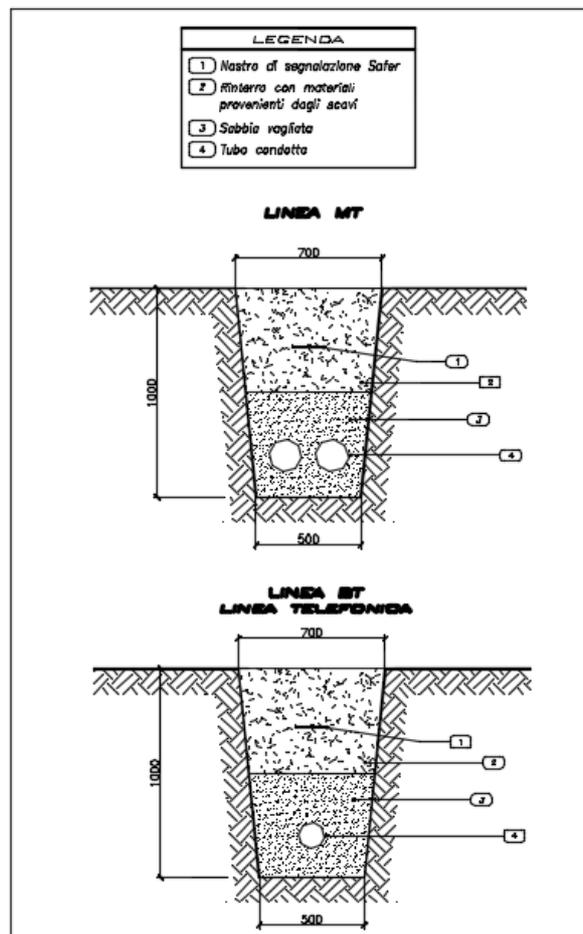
Stralcio planimetrico risoluzione interferenza telefonica e elettrica
